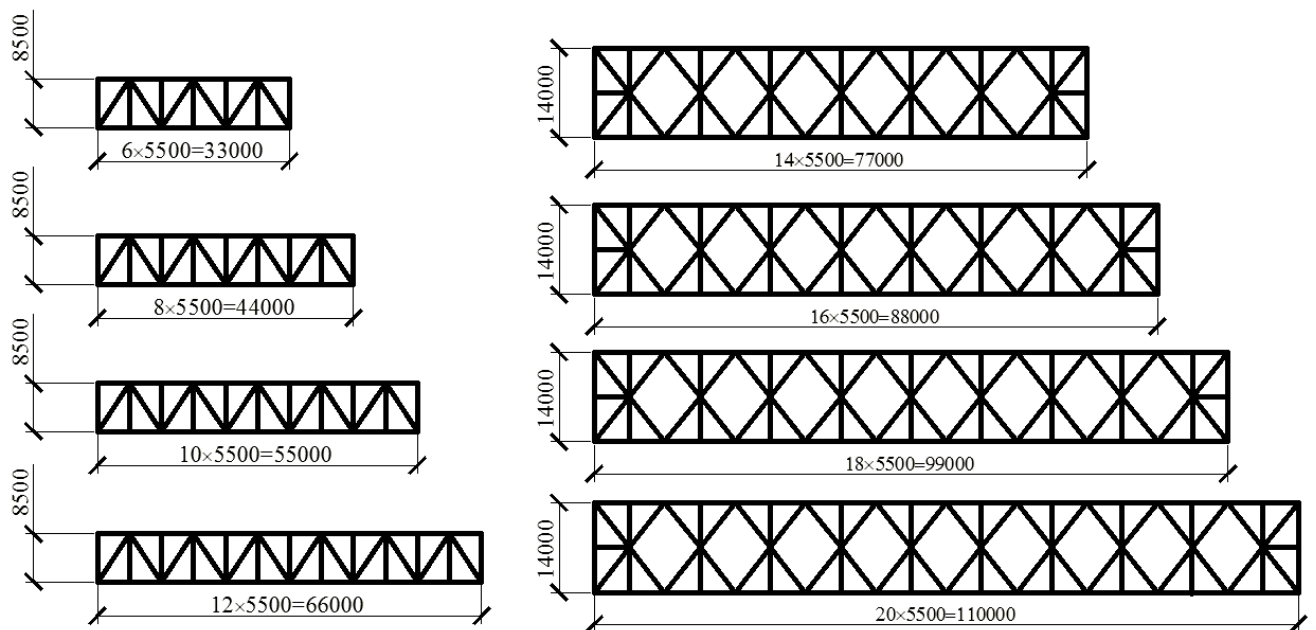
Схеми головних ферм прогонових будов ПСК
